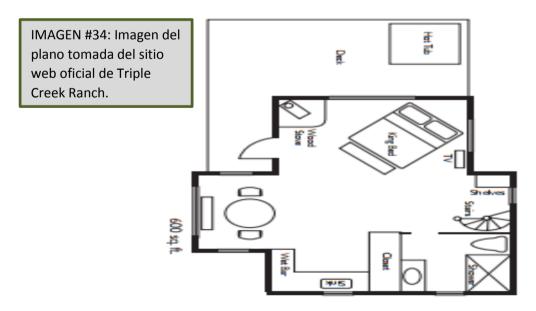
Imagen del plano tomada del sitio web oficial de Triple Creek Ranch.
